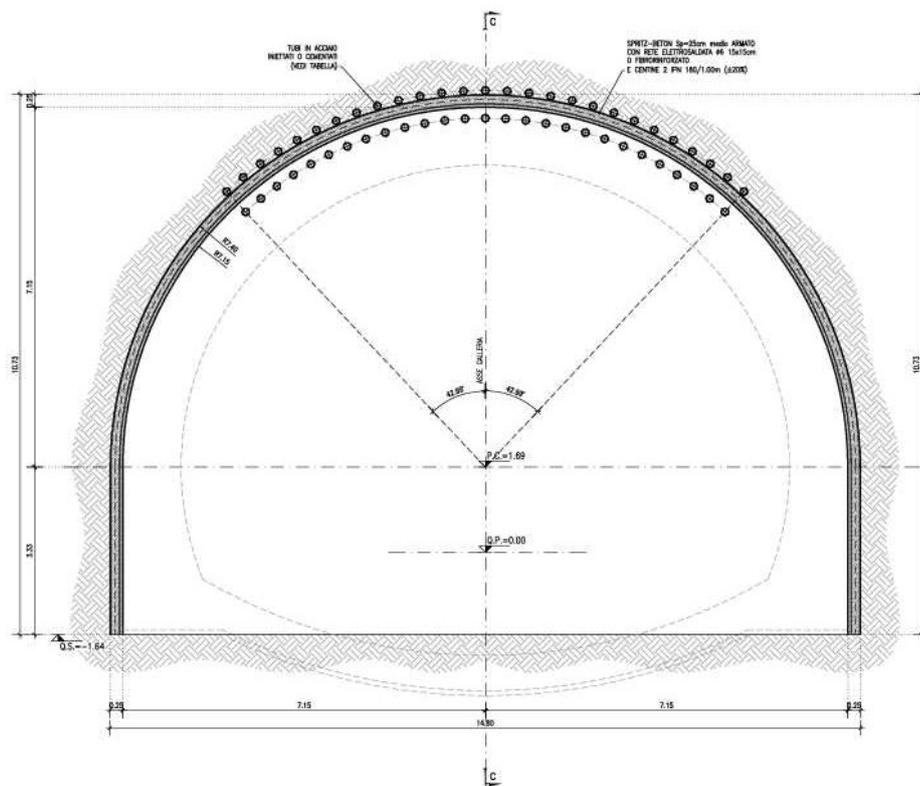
Sezione di scavo tipo B1V – Sezione trasversale
